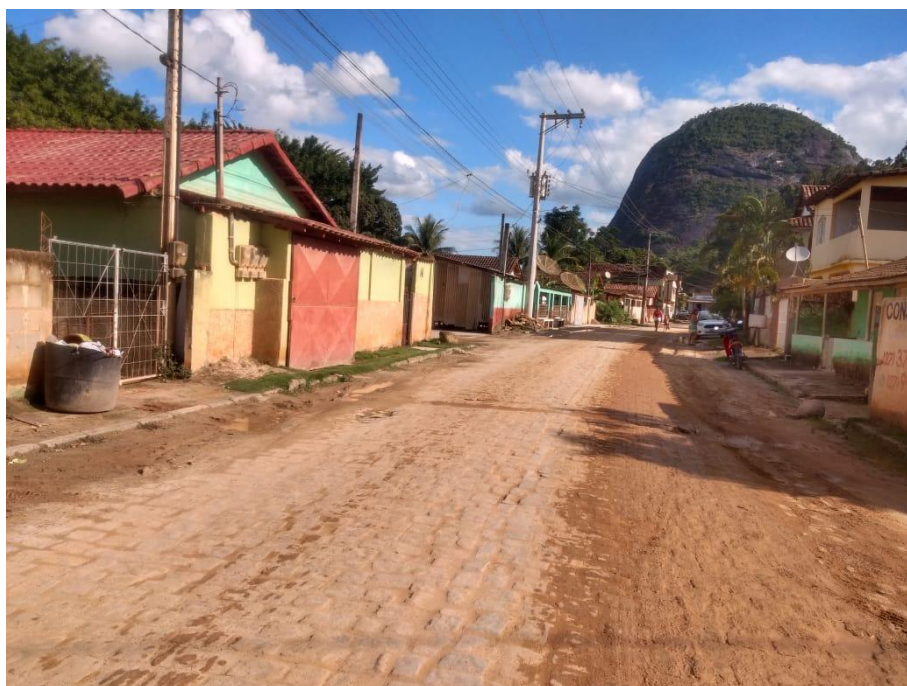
Detalhe para o percurso pavimentado do acesso em Boa Vista.
